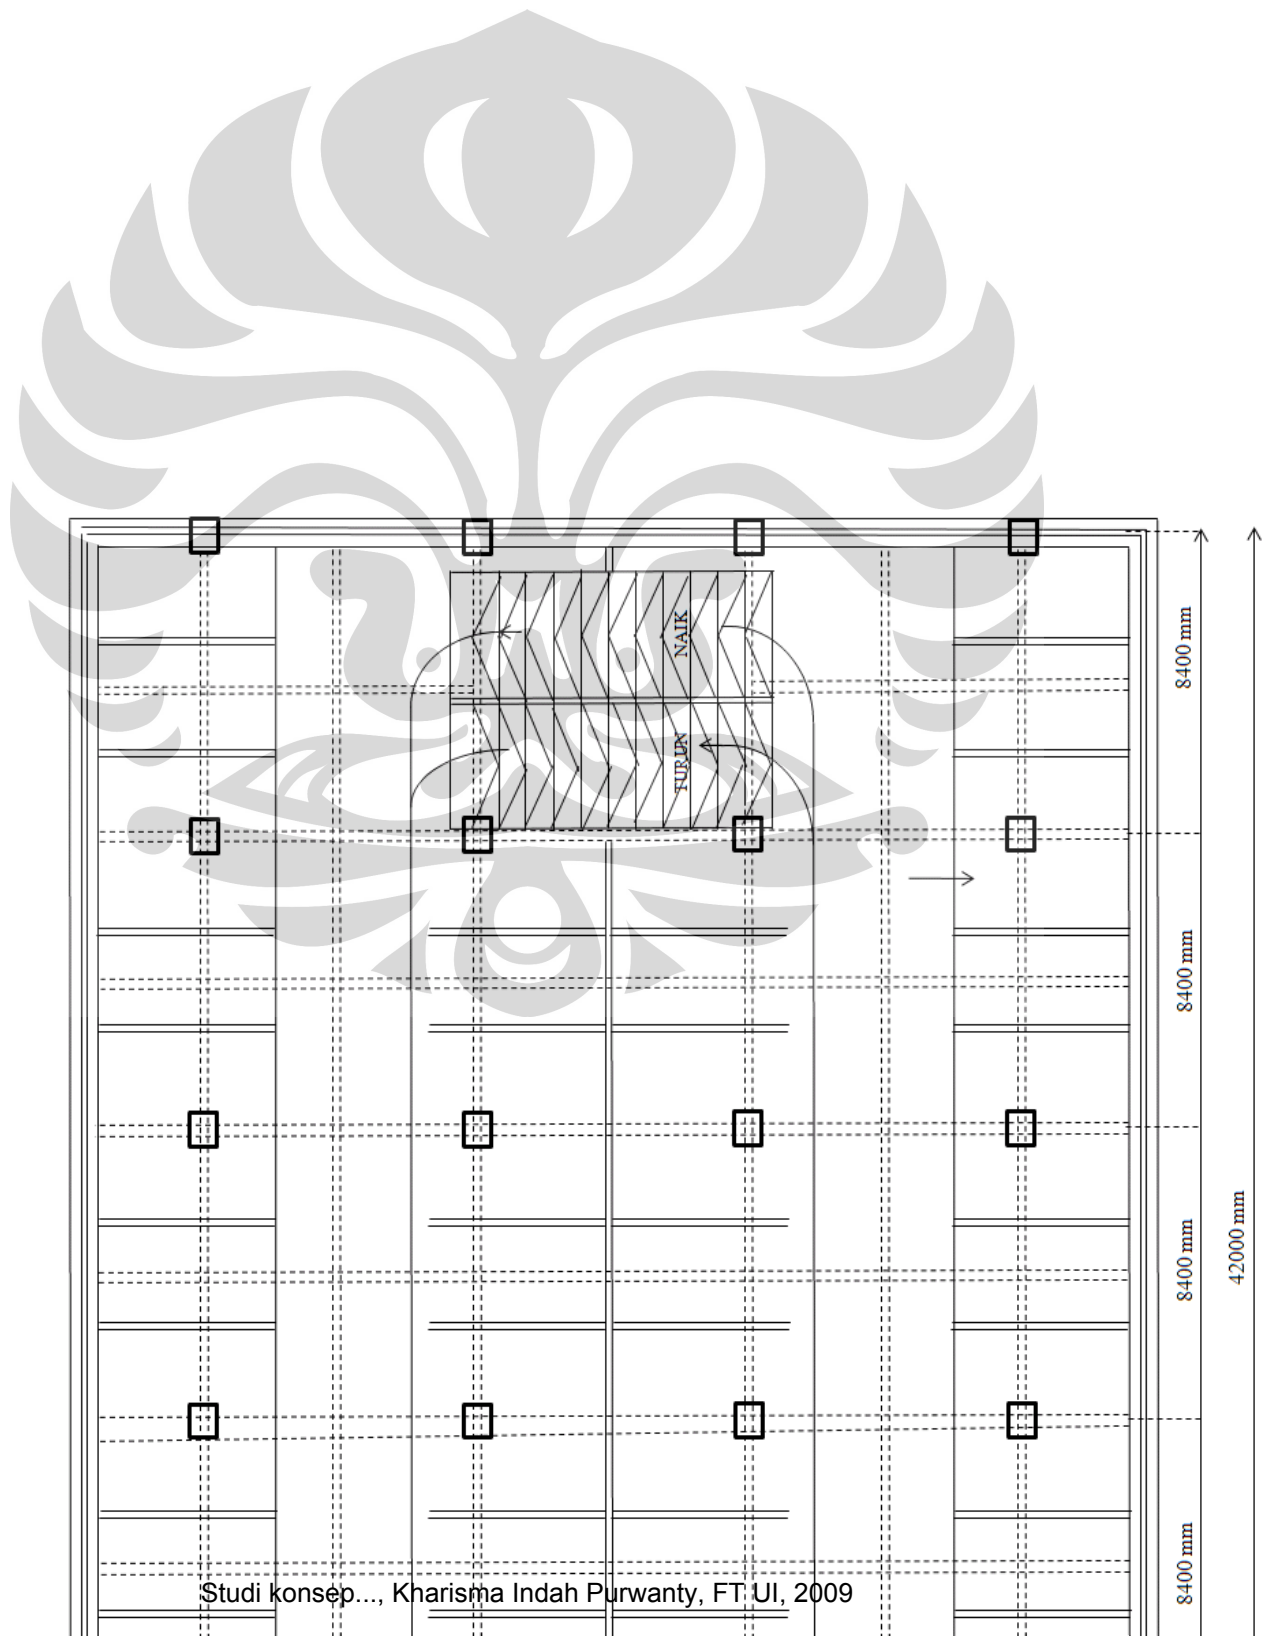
merupakan gambar detail gedung parkir kondisi eksisting pada lantai 3 yang dapat menampung 36 kendaraan.
